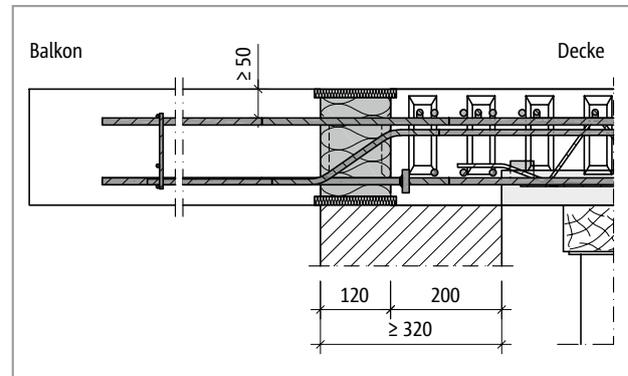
Schöck Isokorb® XT Typ C: Elementplatte mit Randunterstützung mit wärmedämmendem Mauerwerk (Schnitt XT Typ C-R-CV50, Ansicht XT Typ C-L-CV35)
